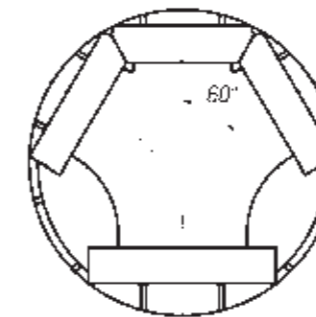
Схема устройства лотка 630–800 мм с боковыми подключениями под 60° (вид сверху)
